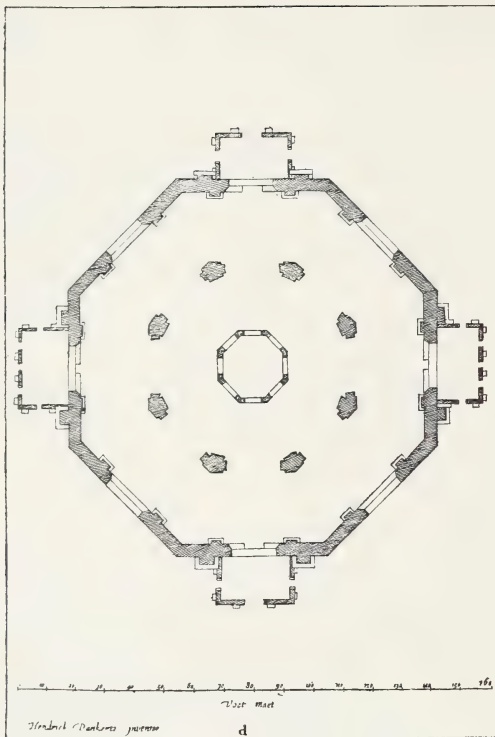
Fig. III. Grundriss. Achteckige Kirche (Arch. Moderna).
